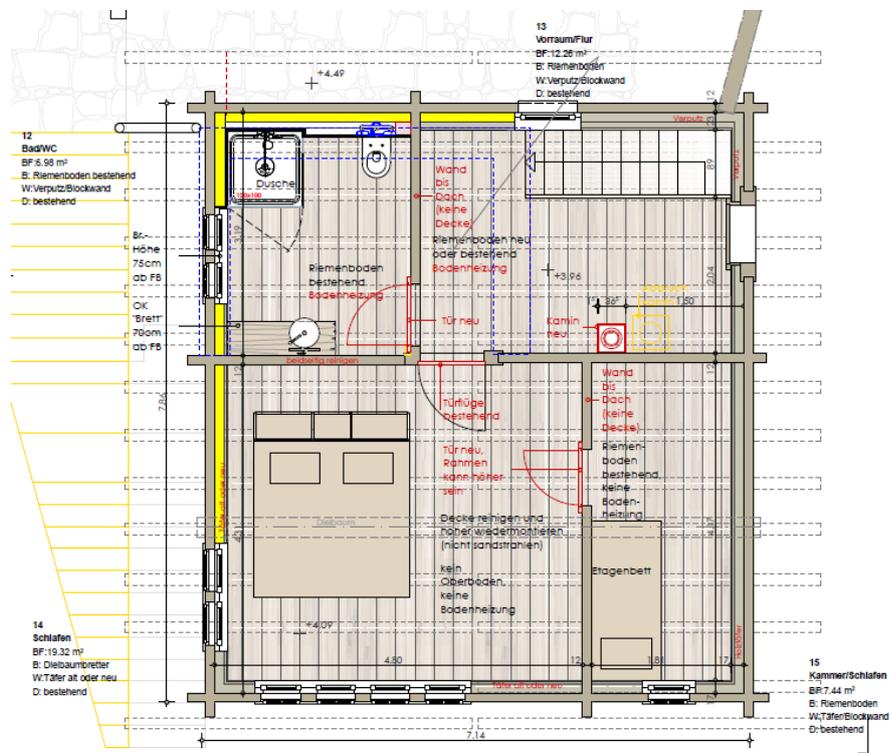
Unmassstäblicher Planausschnitt des Grundrisses 2.OG - Wohneinheit 2
